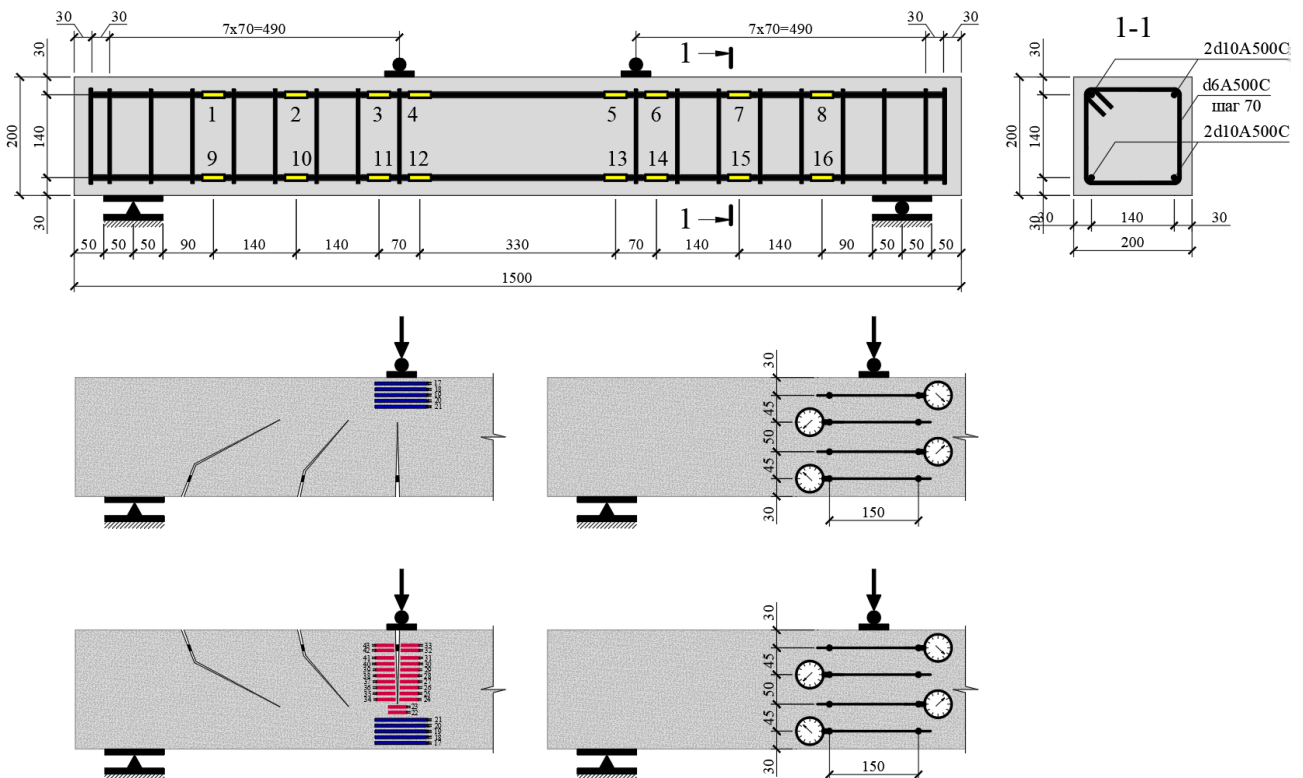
Схема расположения тензодатчиков на арматуре для балок серий II-VII; Схема расположения цифровых индикаторов и тензодатчиков на бетоне для балок серий II-VII
